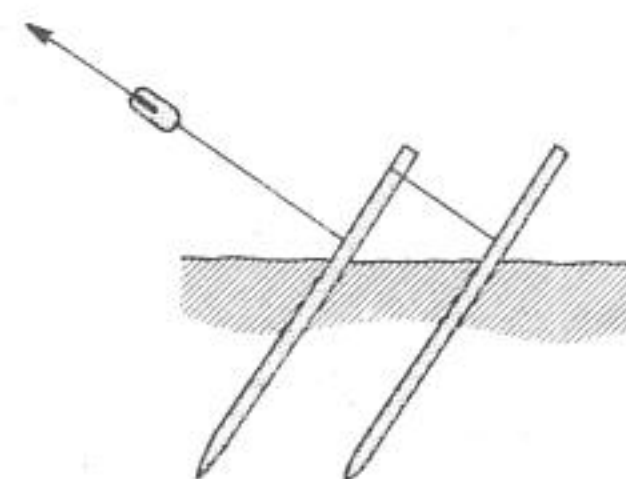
Système de fixation au sol au moyen de câbles de fixation. On peut noter deux piquets qui, grâce à leur disposition, subdivisent l'effort. Dans quelques cas, un seul piquet est suffisant.
